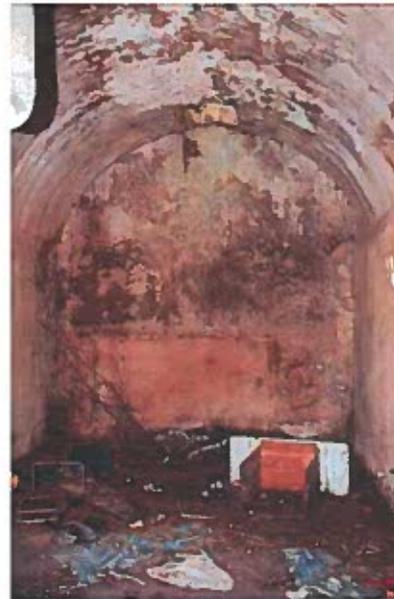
Vue générale de la voûte en berceau, traces d'humidité, remontées capillaires
